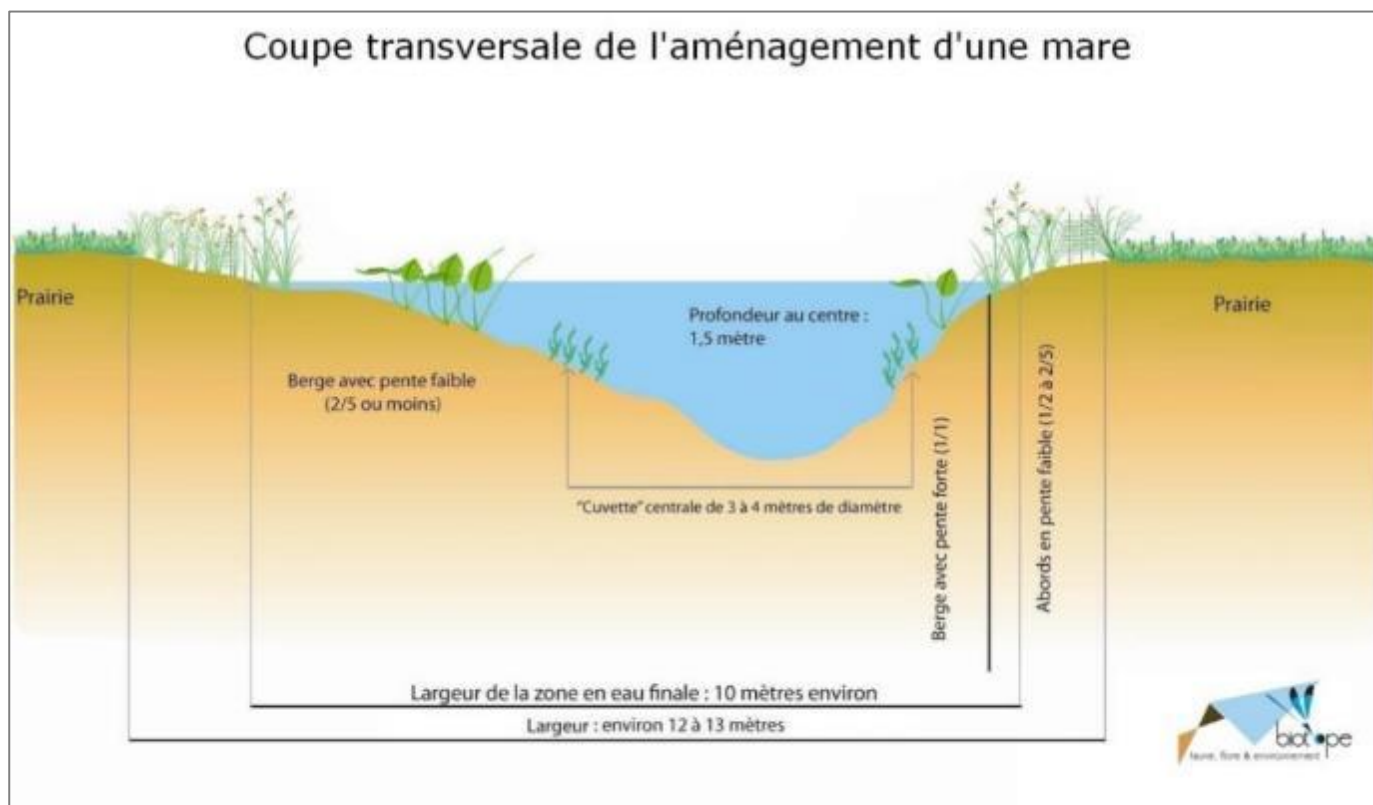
Coupe transversale type d'une mare (source : plan de gestion de l'ENS – biotope).
